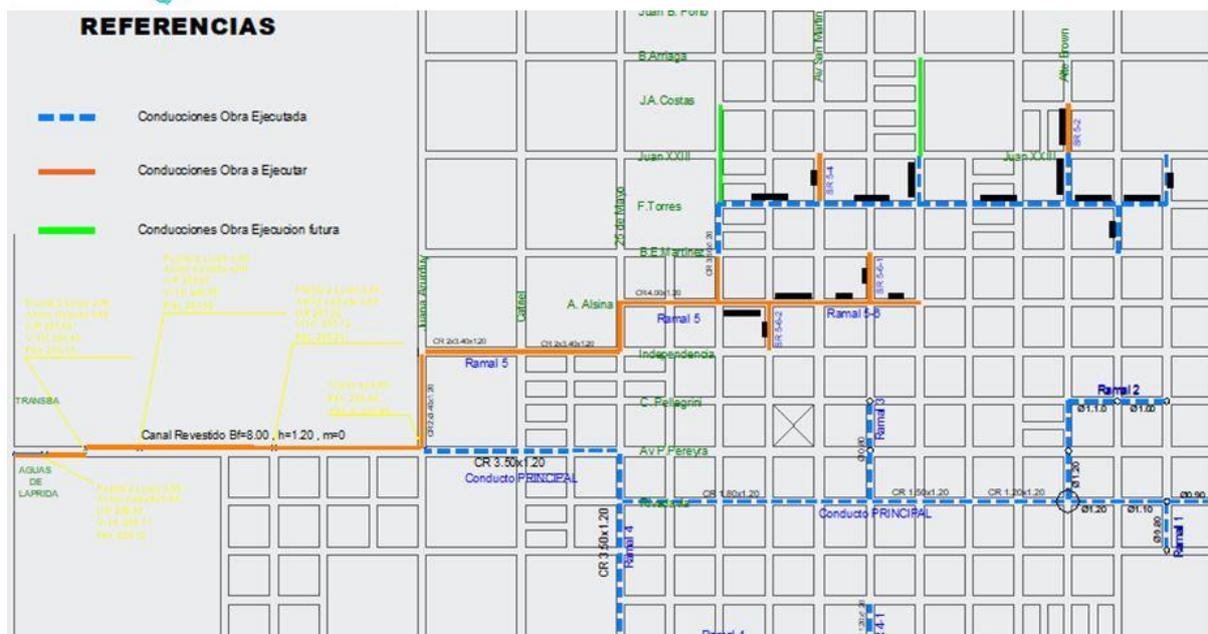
Planimetría del proyecto con detalle del trazado de obras ejecutadas, a ejecutar y obra de ejecución futura. Fuente: EIA.
